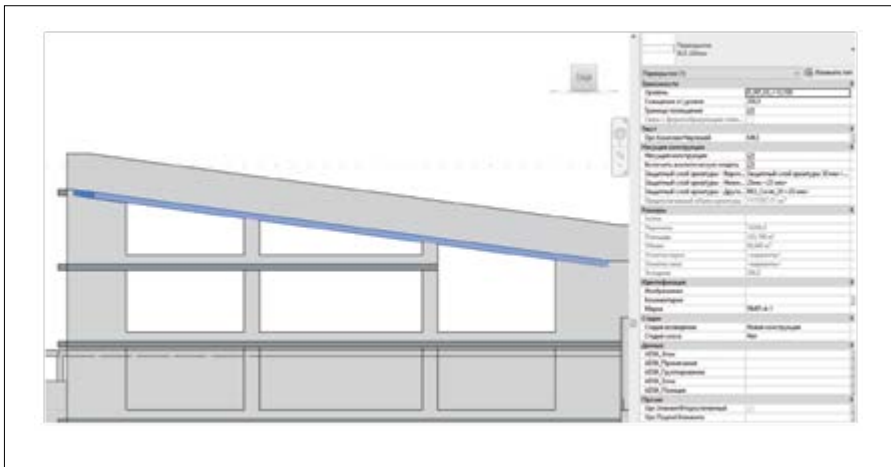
Наклонное перекрытие кровли и его параметры в BIM-модели
